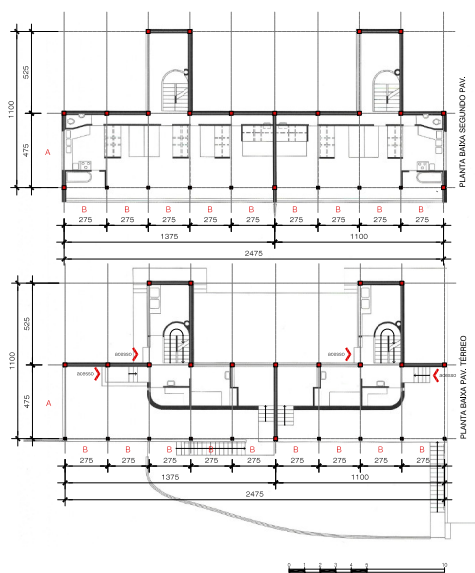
Modulação Estrutural. Primeiro e segundo pavimentos.
